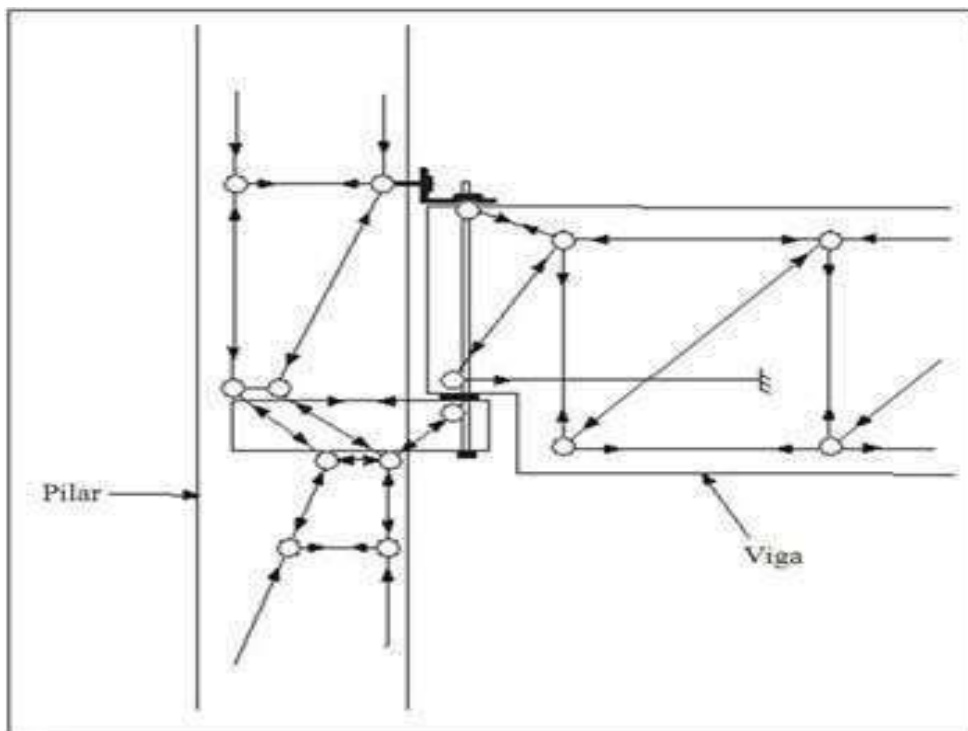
Trajetória das forças em uma ligação viga-pilar com consolo metálico embutido
